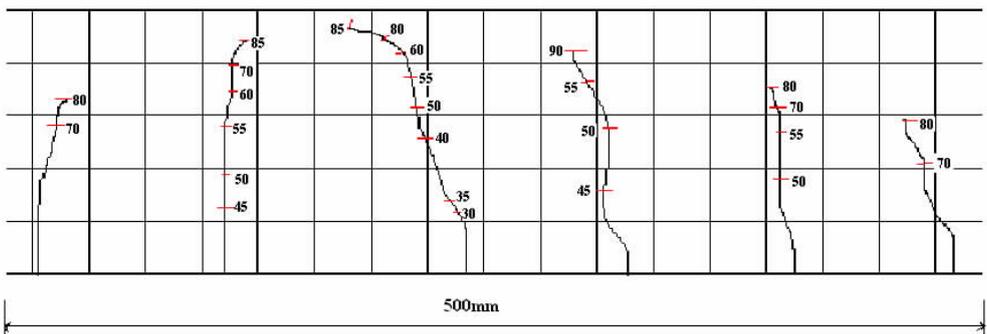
在分级载荷作用下基准混凝土配筋梁的裂缝传播过程
